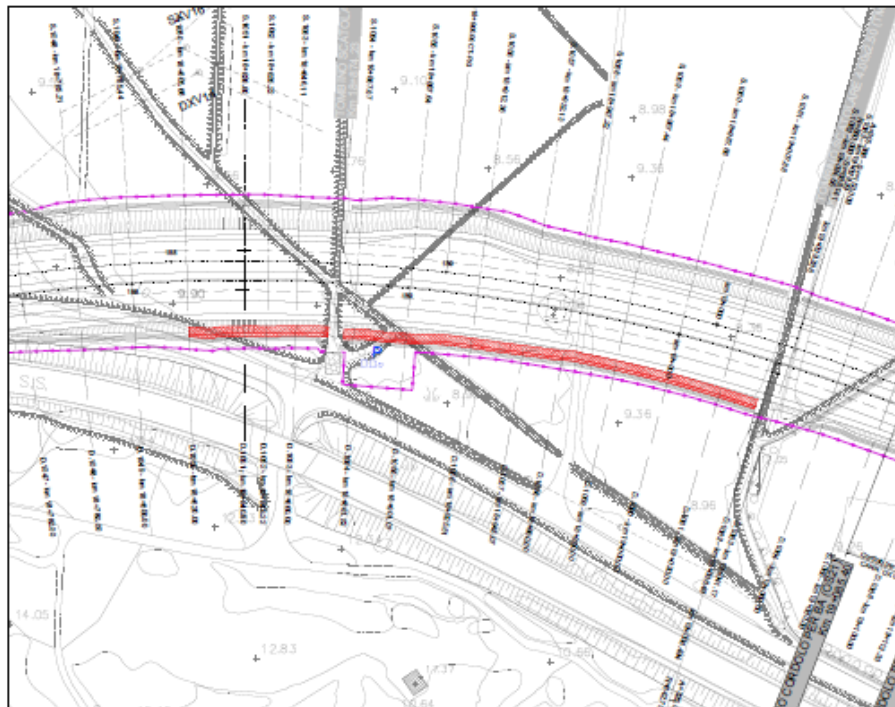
protezione rilevato da km 18+820 a km 19+033.
